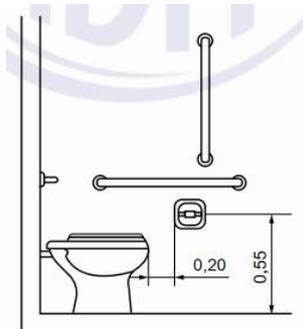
Localização da papeleira embutida – Vista lateral
